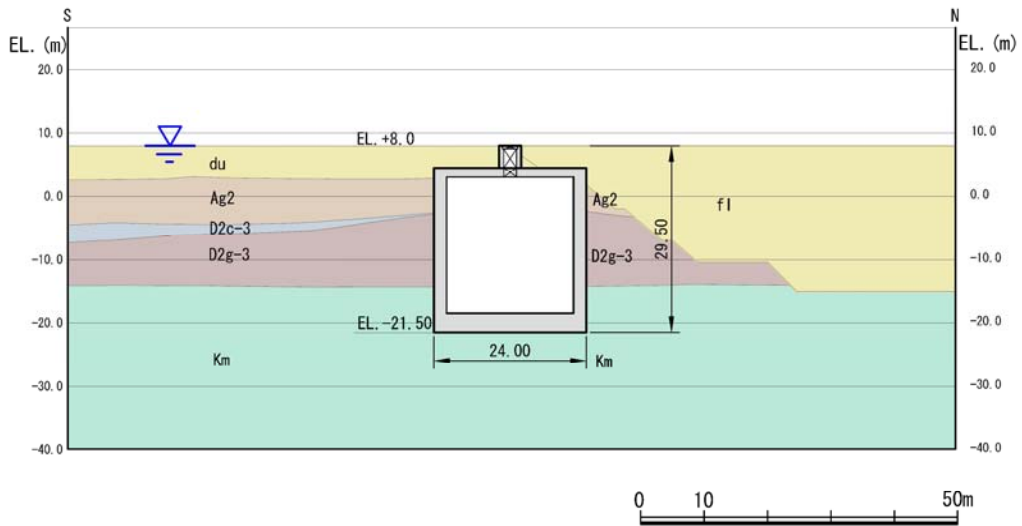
(4) 代替淡水貯槽地質断面图 (B-B 断面)
